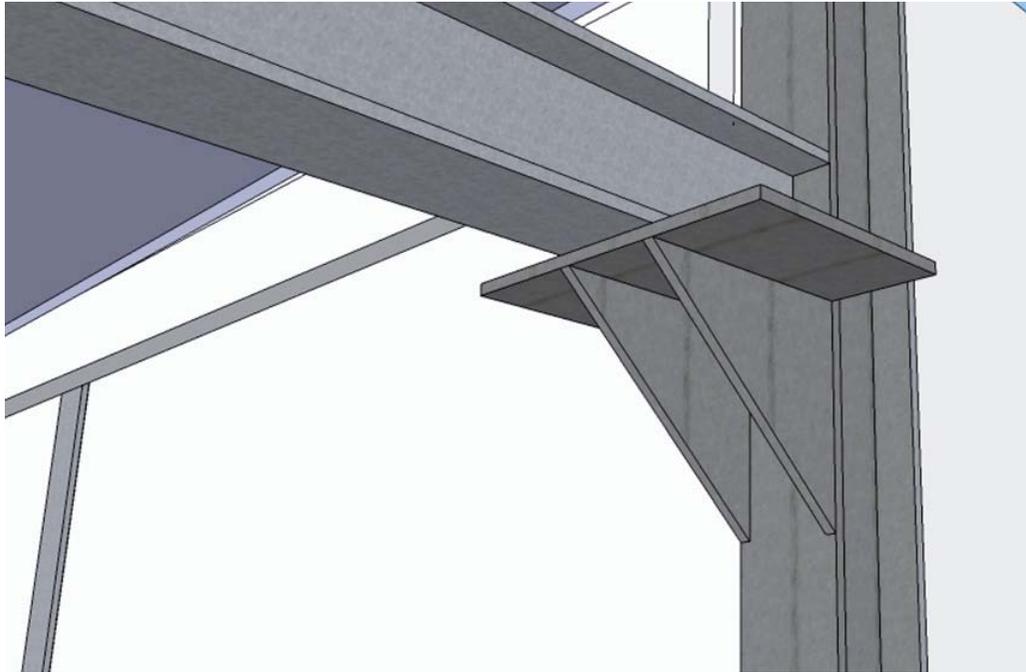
Detalle unión entre vigas y muro de contención. (imagen diseñada en Google Sketchup)
